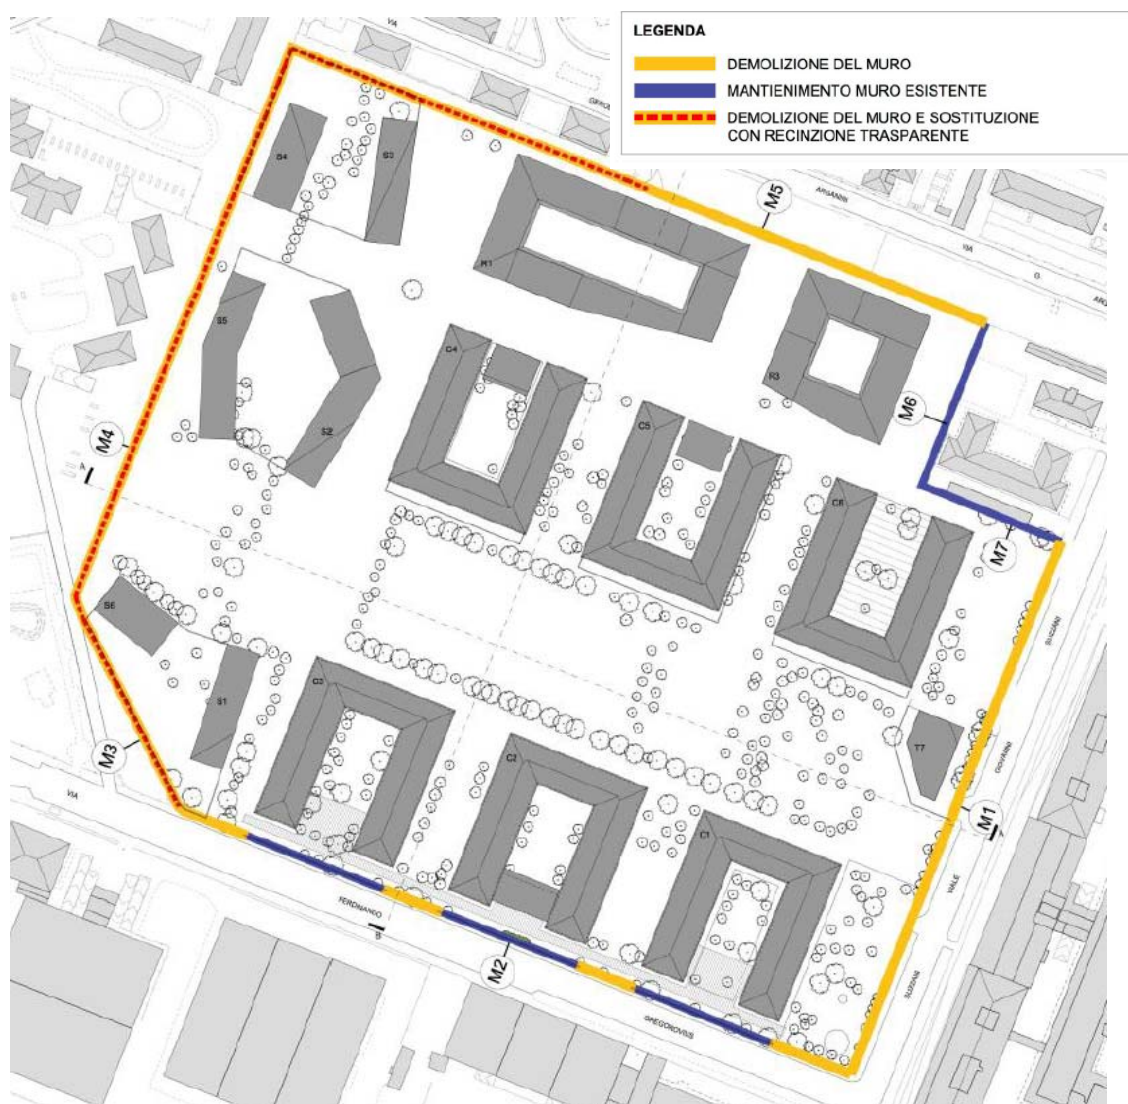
Progetto di intervento sulla muratura perimetrale
